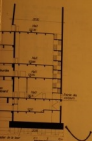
(à droite). — Coupe transversale, niveau 2-2, aux abords 118,00 à 127,35 (au droit de la rampe forcée).
